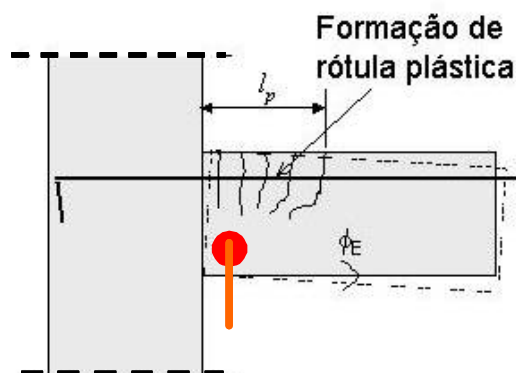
Posicionamento do clinômetro na região com menor risco de fissuração.
